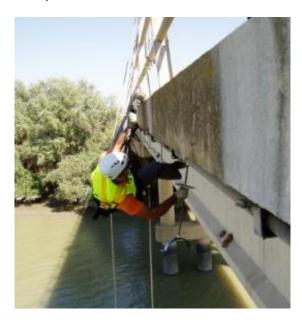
PERFORACIÓN PARA COLOCACIÓN DE TAQUETES PARA ADOSAMIENTO A PUENTE.
